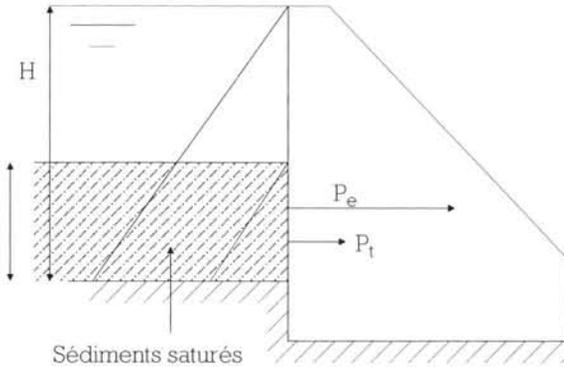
La poussée des sédiments saturés s'ajoute à la poussée hydrostatique.
